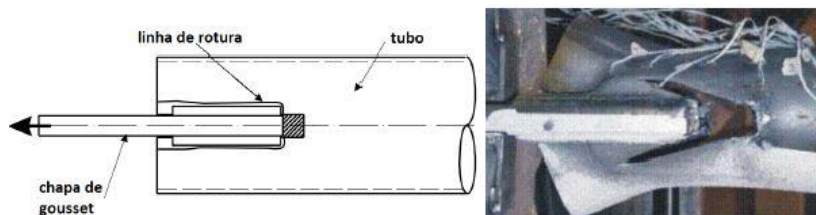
a) linha de rotura do corte em bloco; b) fratura de um provete, [41]
